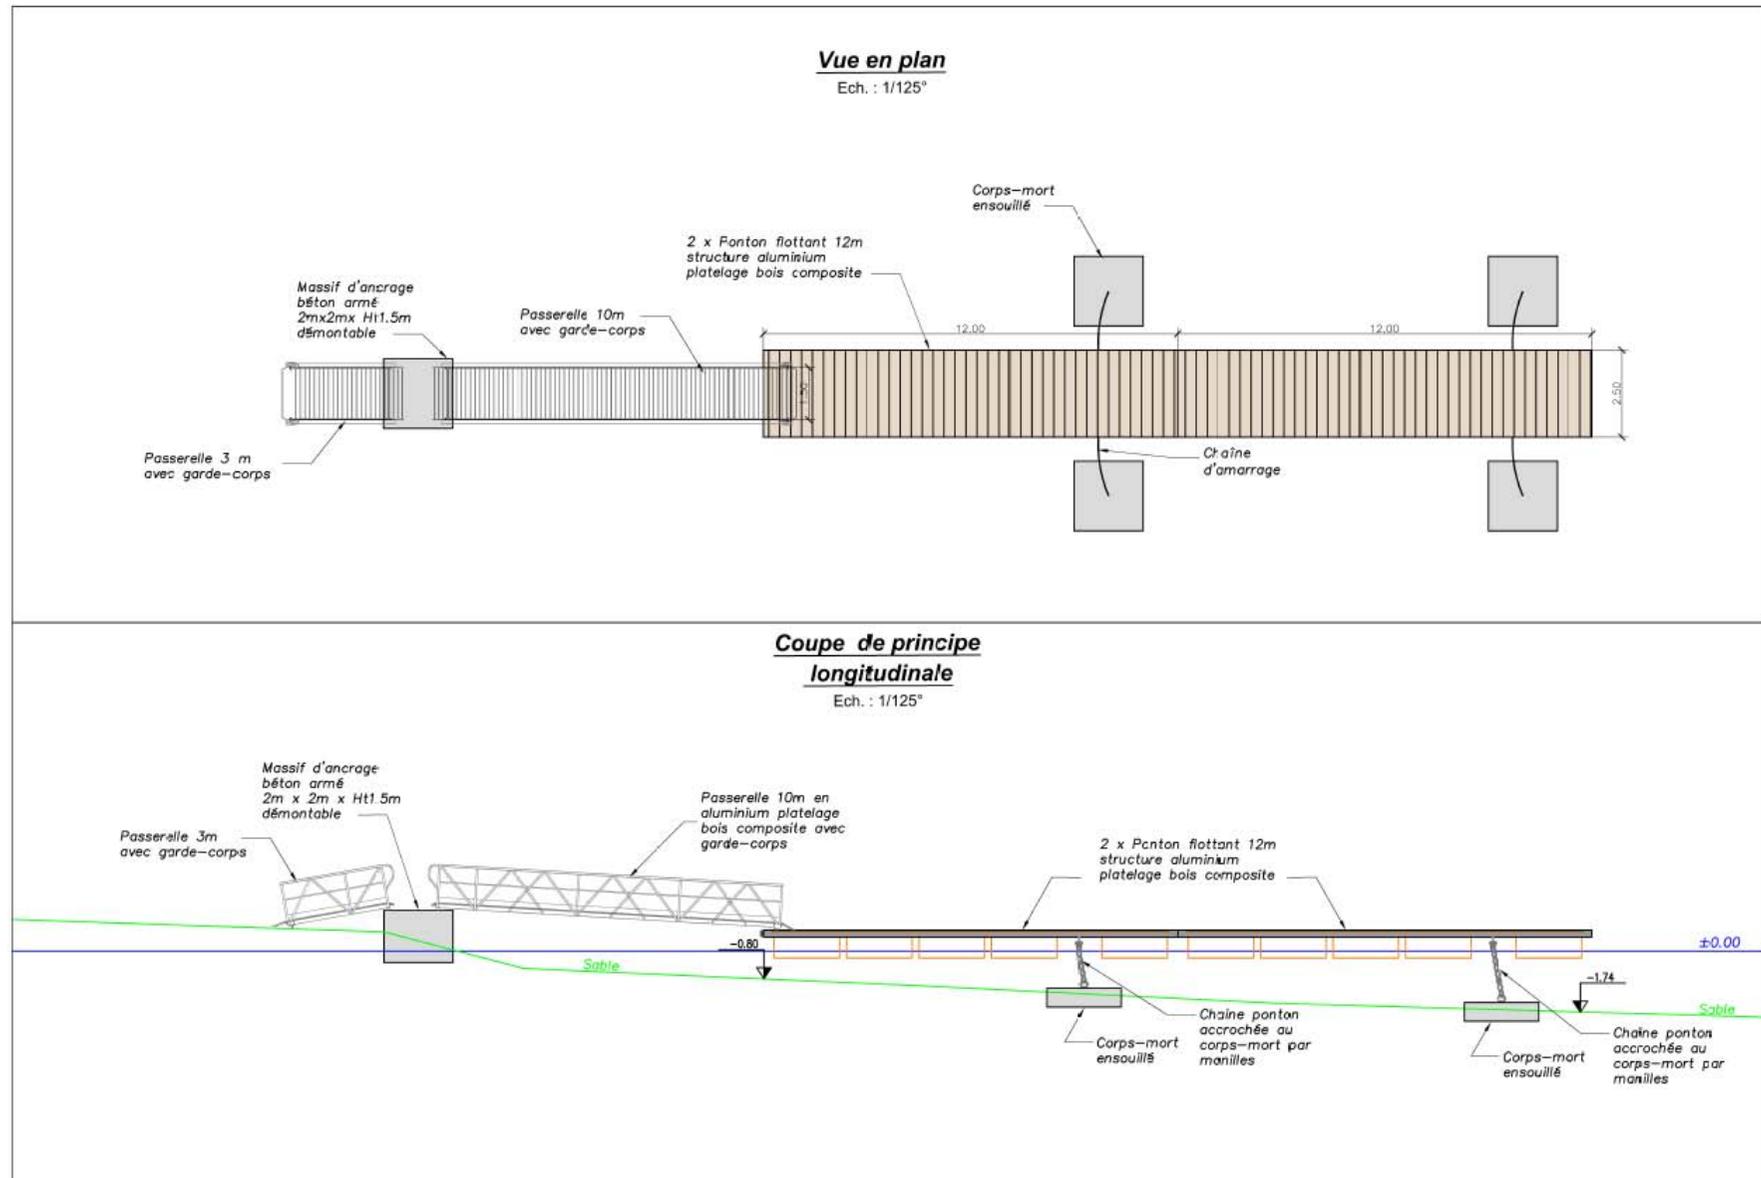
VP et coupe ponton flottant – Solution ponton 1
